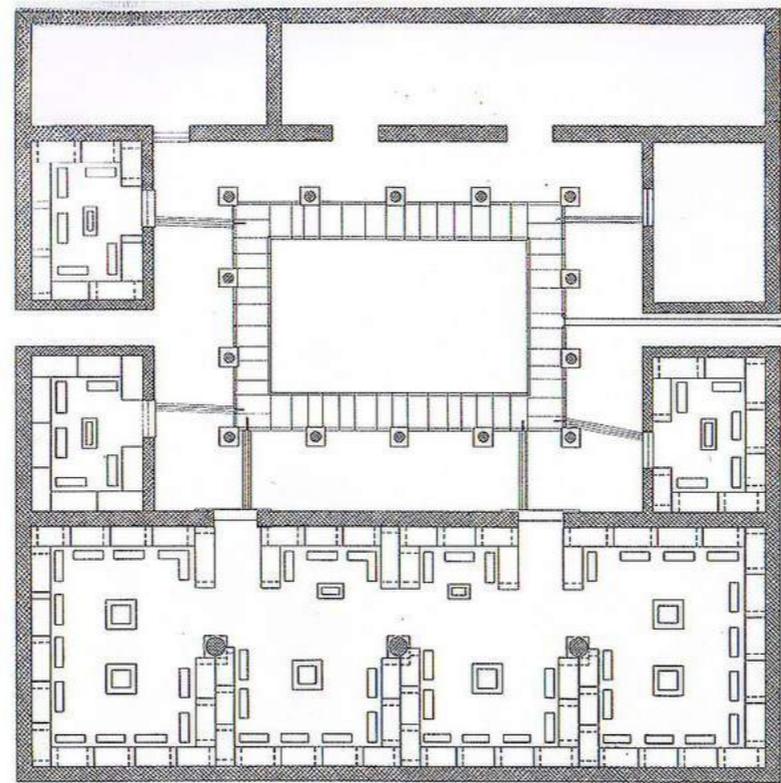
Asklepieion von Troizen, 400 v. Chr., Grundriss Herberge
